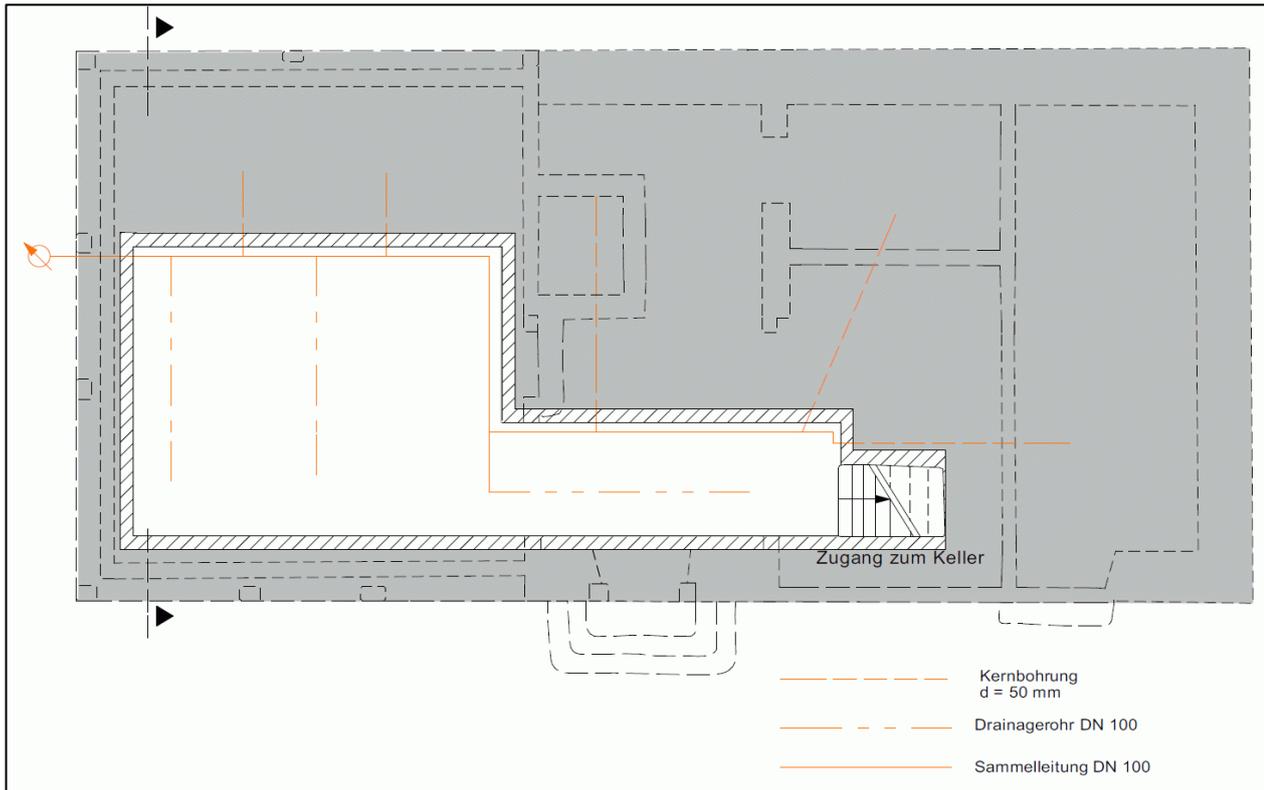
Grundriss Kellergeschoss, innen liegende Radondrainage
